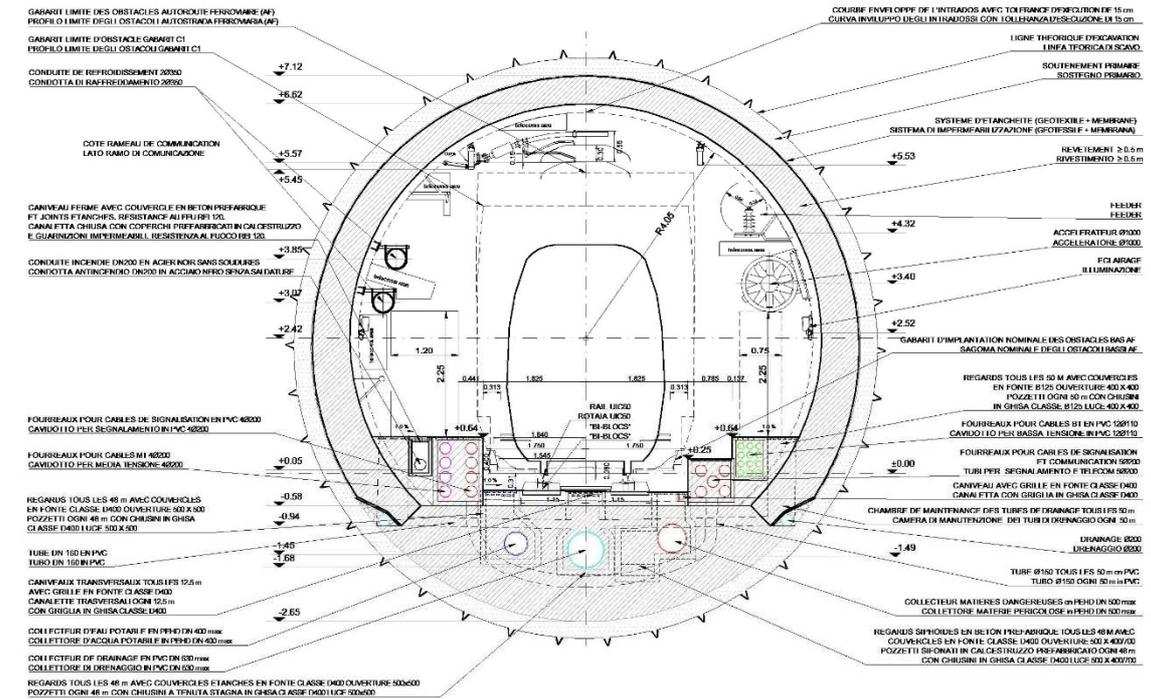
Sezione tipo Tunnel di Base: scavo con TBM aperta
